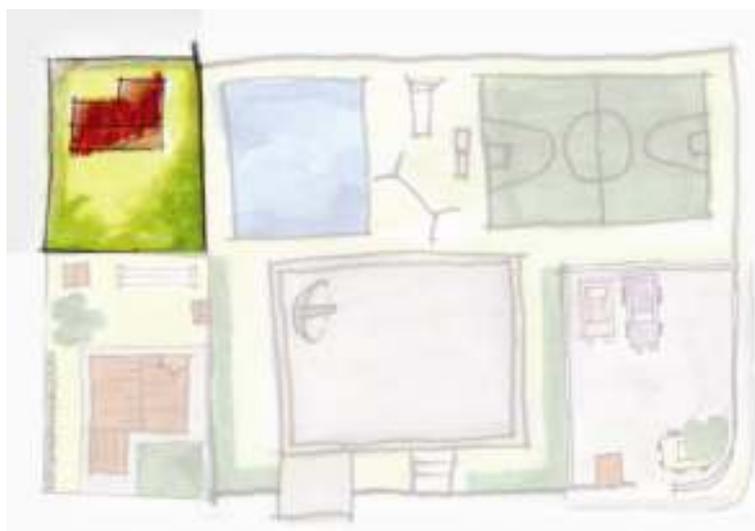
Espaço livre privado: Lote vazio de edificação com casa em deteriorização.
